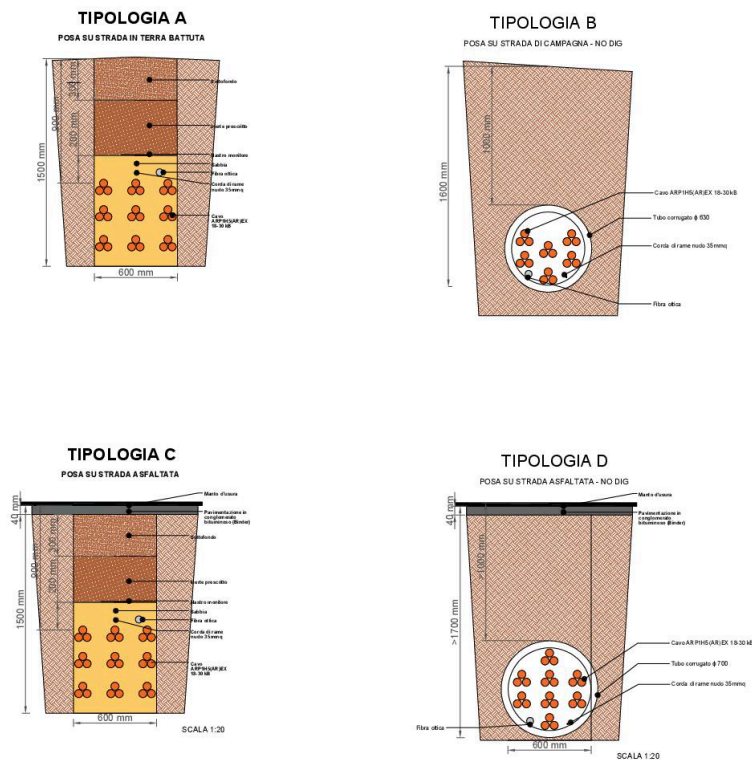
Particolare sezione tipo cavo interrato MT e particolari della sezione stradale
